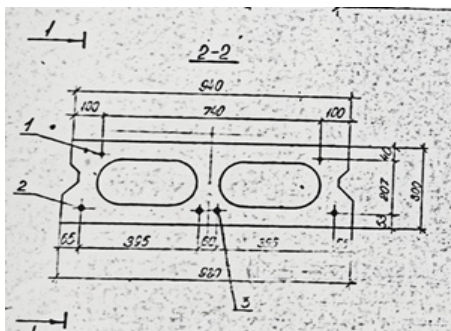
Зображення армування попередньо напруженою арматурою плити довжиною 6 м
